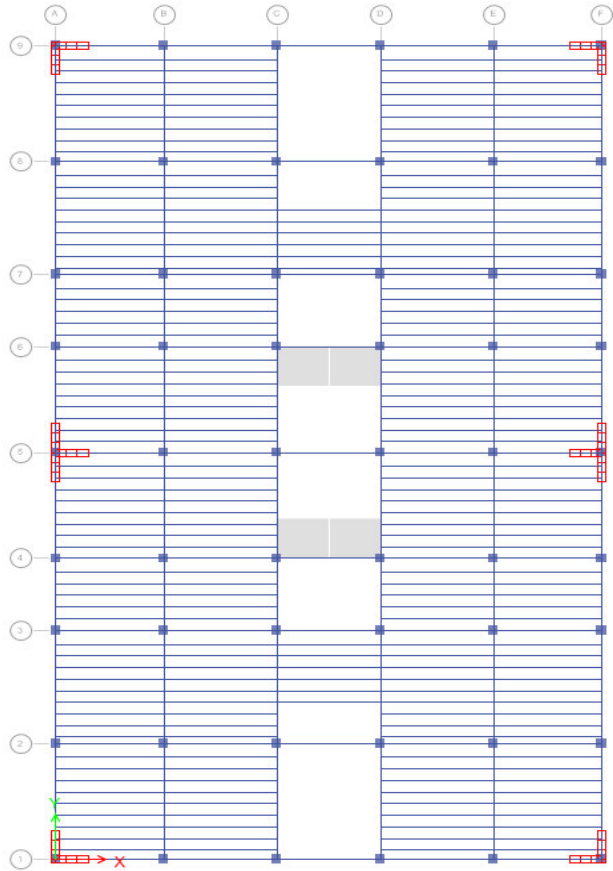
Vista en planta del 1er, 2do y 3er nivel
